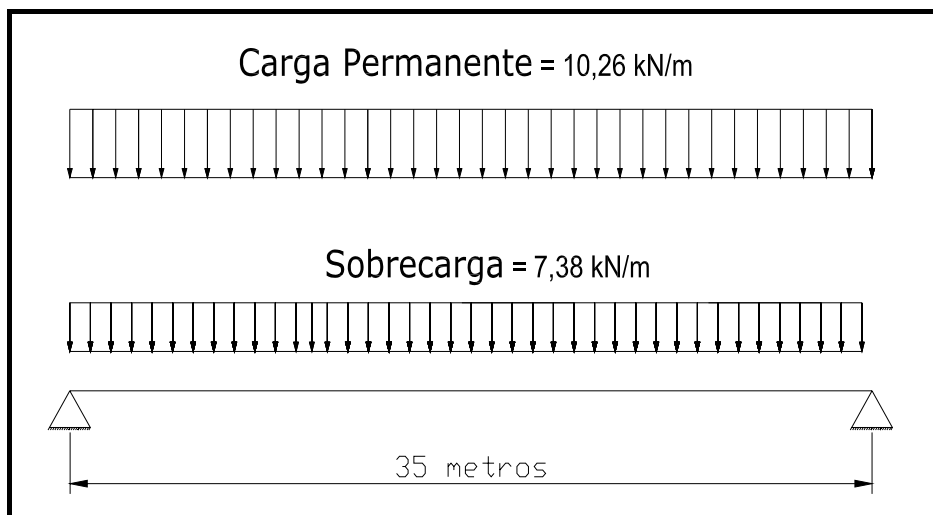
Esquema estrutural adoptado para a análise longitudinal da viga mista durante a fase de serviço da estrutura.
